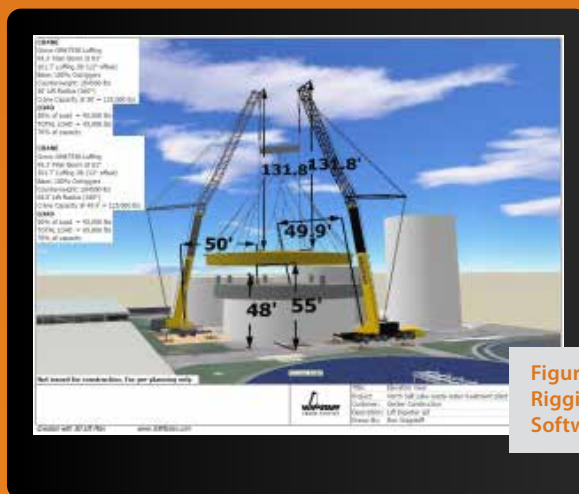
Plano de Rigging em 3D no Software 3D Lift Plan
